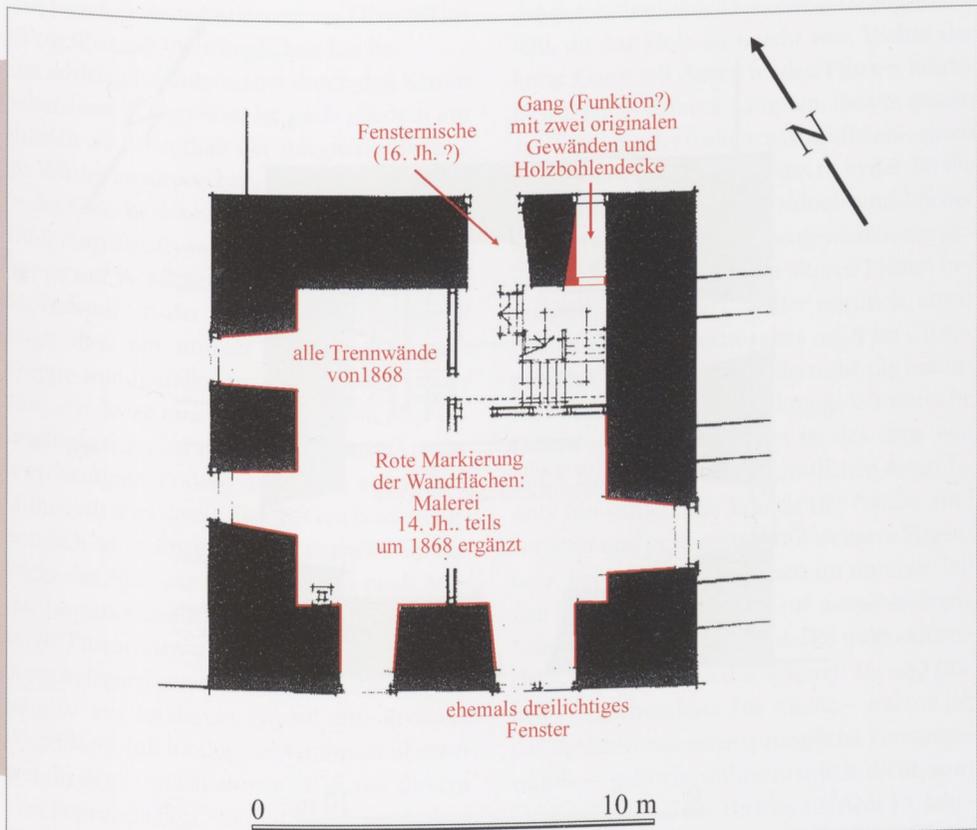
Maienfeld, der Wohnturm, Grundriss des 5. Geschosses mit Hinweisen auf mittelalterliche (und jüngere) Befunde in rot (Th. BILLER, Grundlage wie Abb. 5).
